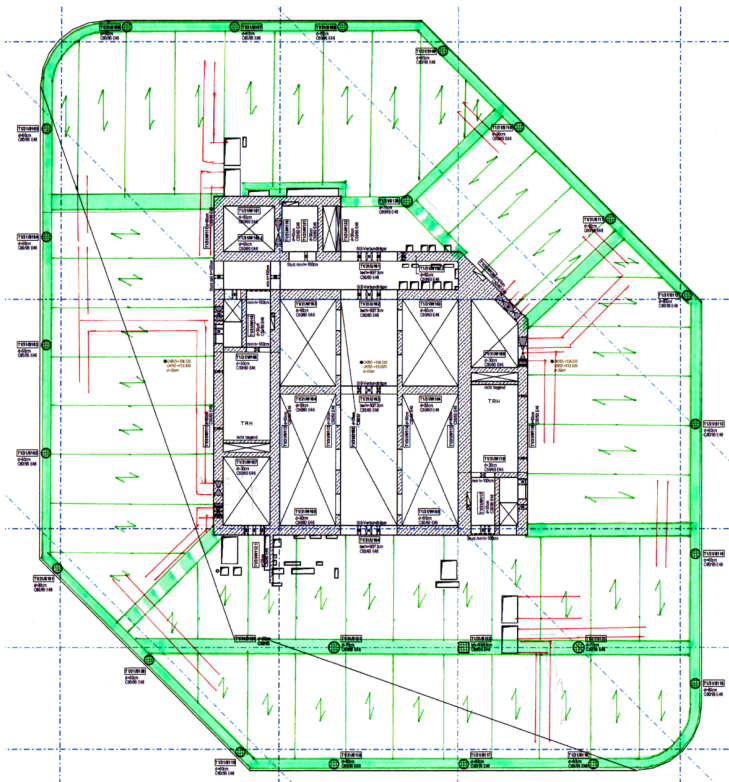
Deckengrundriss mit Unterzügen als Halbfertigteildecke beim RT1
